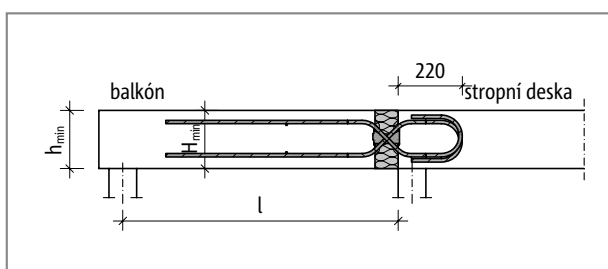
Schöck Isokorb® typ Q40M až Q60M: Statický systém
